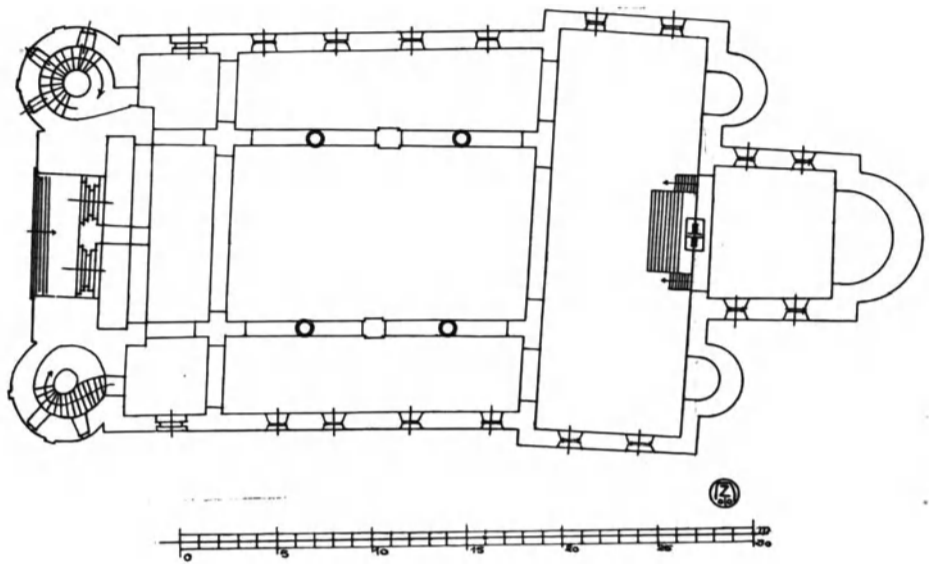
Gernrode. Grundriß von Ostchor und Querhaus im I. Bauabschnitt.
